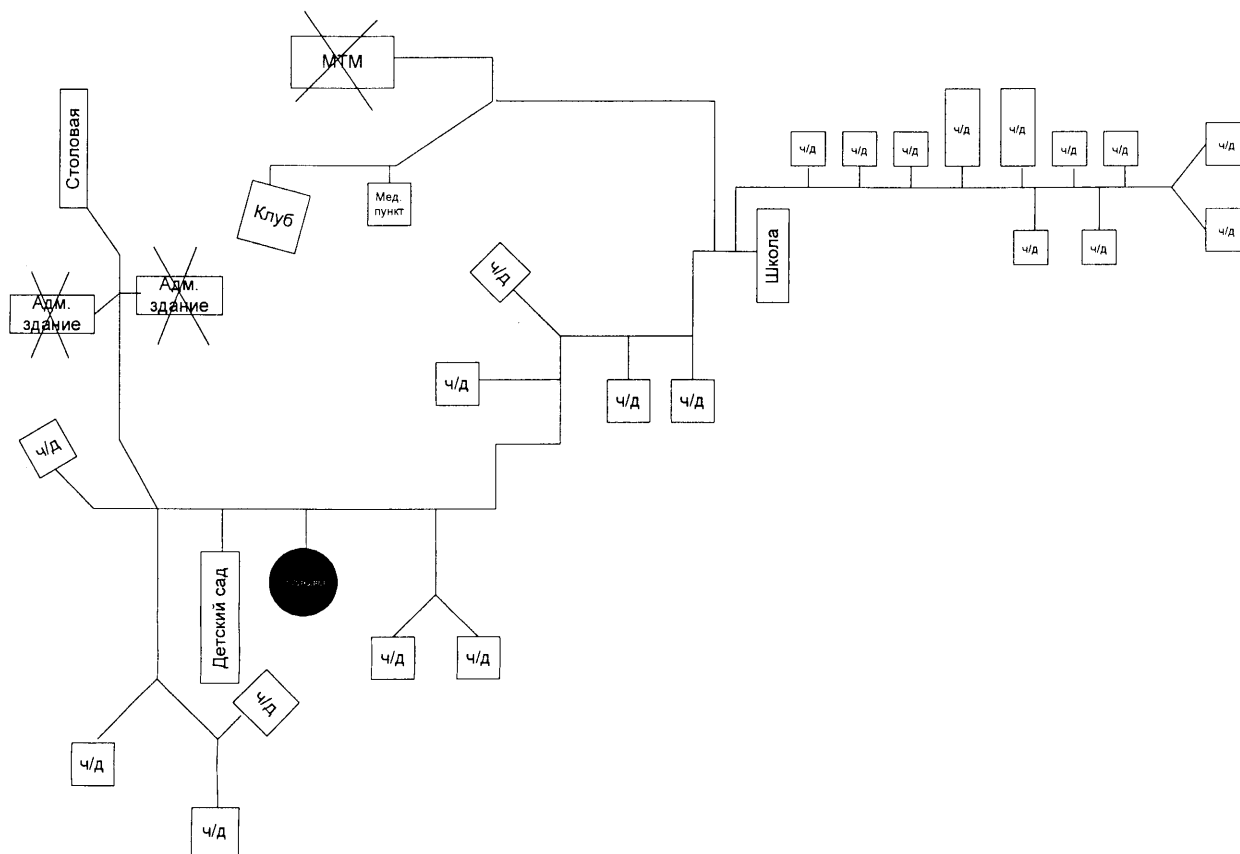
Схема размещения тепловых сетей от котельной с.Вяткино
